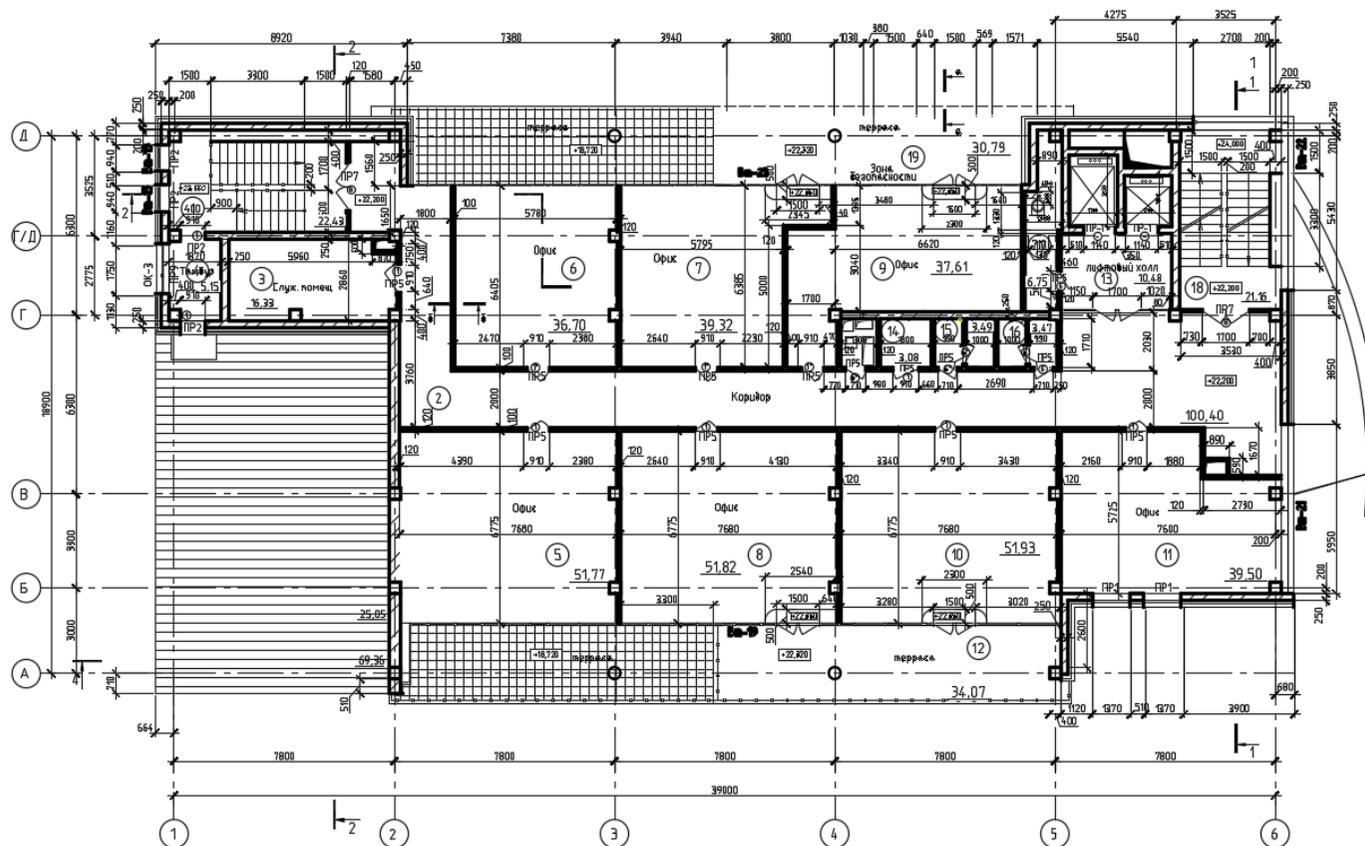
План седьмого этажа на отметке плюс 18,600 м
